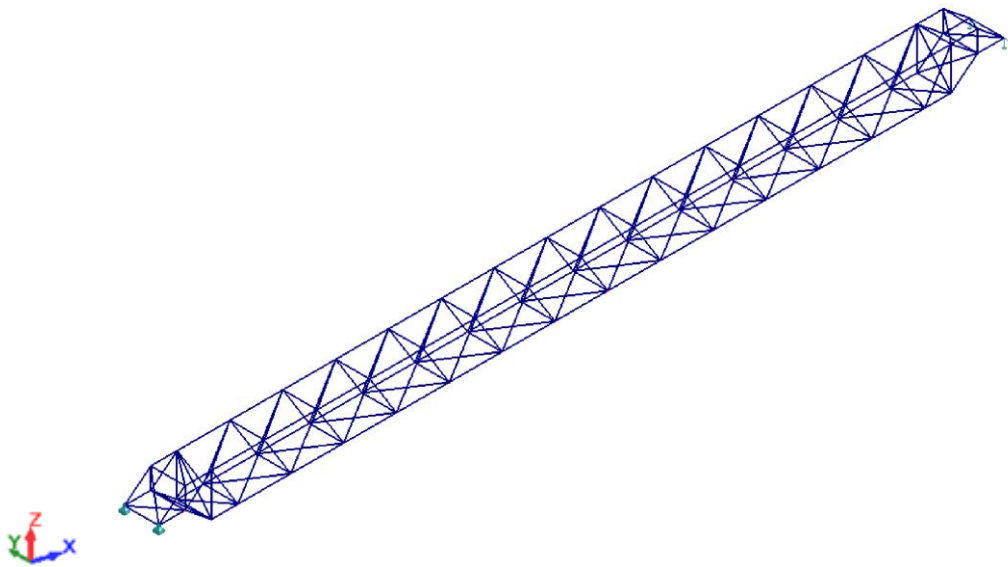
Vista em 3D do modelo da ponte provisória metálica
